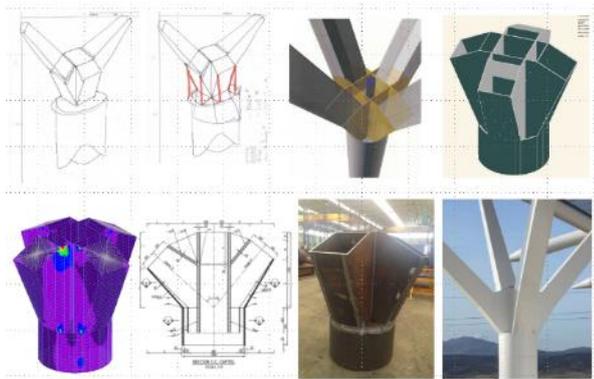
Desarrollo de encaje, dimensionado, detallado, fabricación y puesta en obra de los capiteles.
